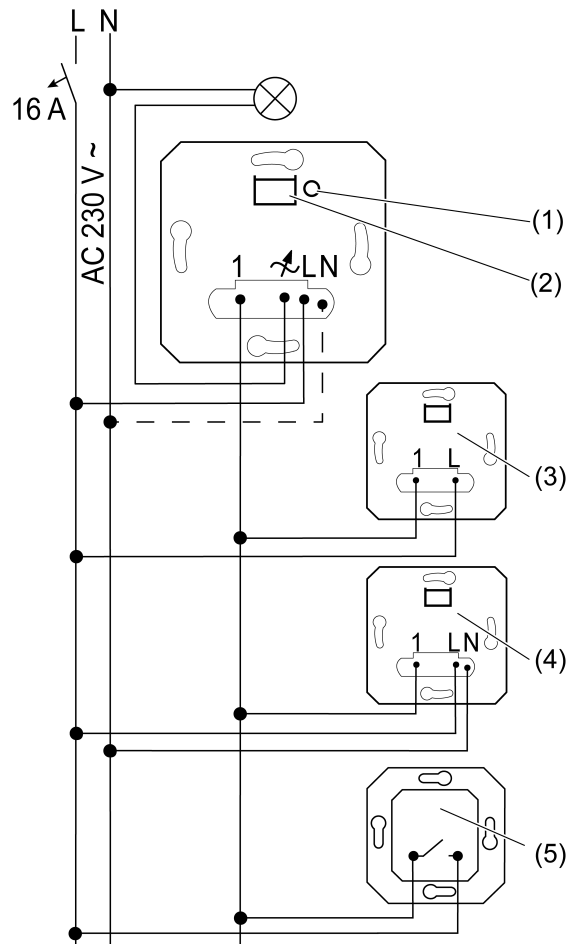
Plan de conexión con mecanismos auxiliares opcionales
